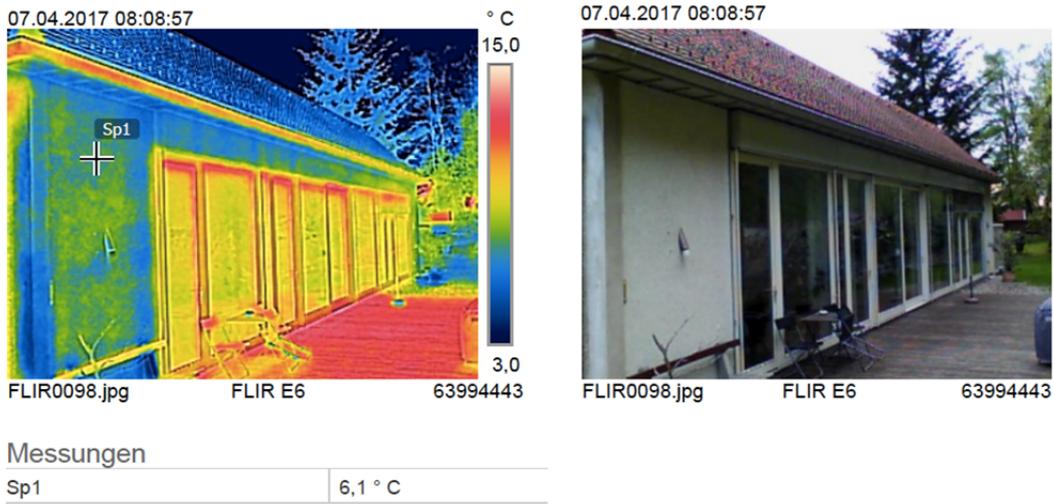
Wärmebild, Westfassade mit Fensterportal
